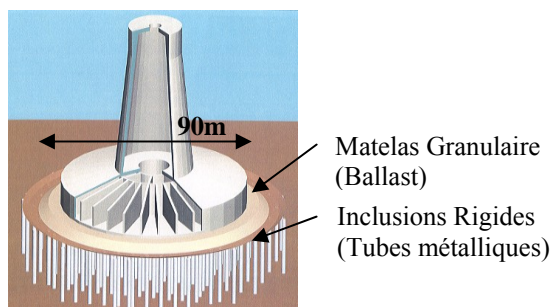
Fondation des piles du pont Rion-Antirion (Rault *et al.*, 2006).
